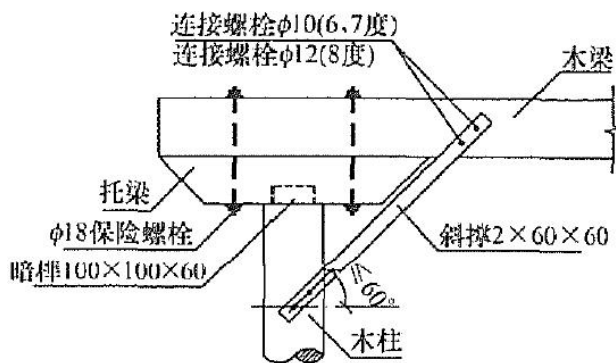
屋架加设斜撑图（单位：mm）
